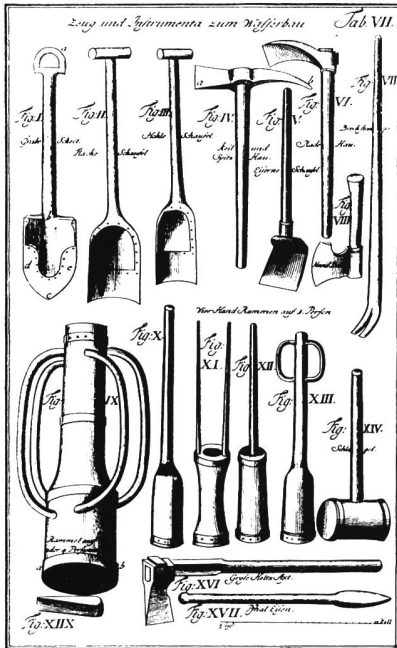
Werkzeuge: «Zeug und Instrumente zum Wasserbau» nach Leupold 1724.
